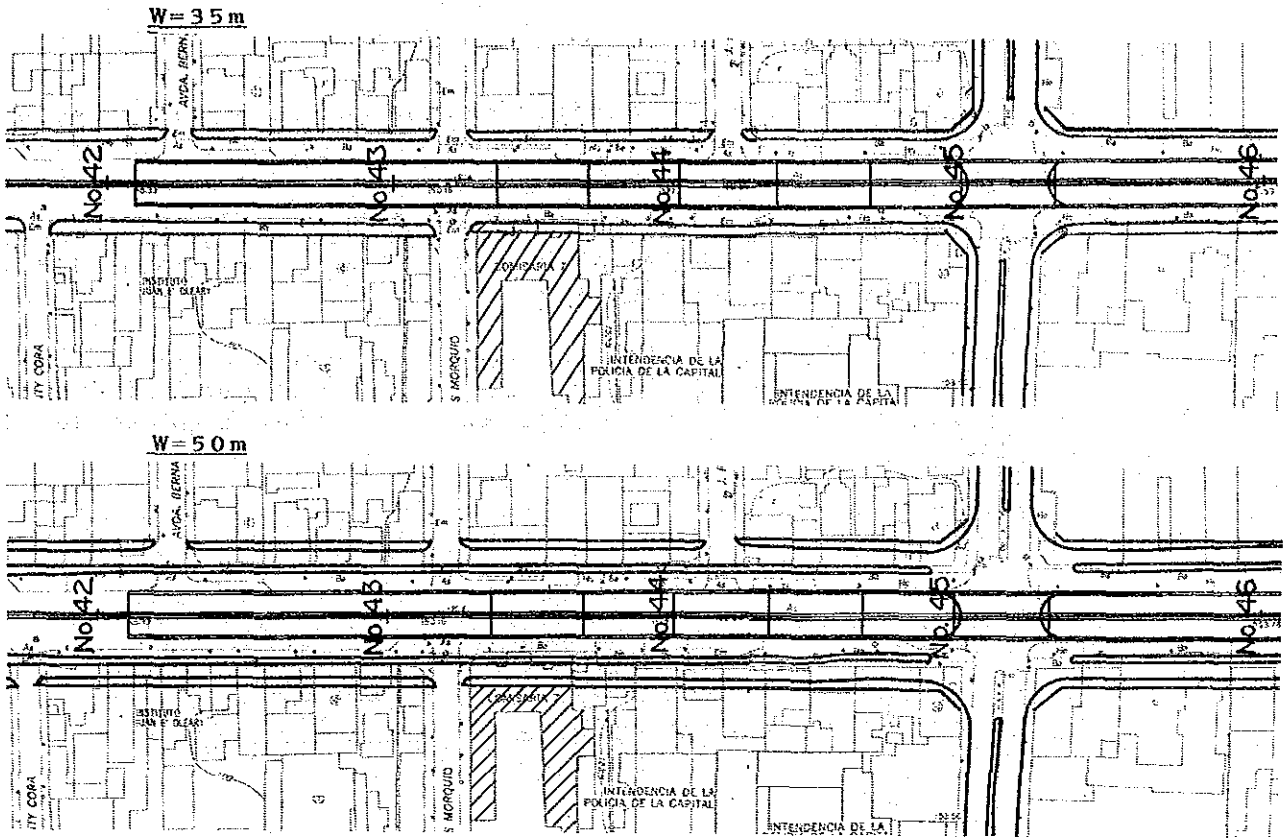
PLANO DE LA AV.E.AYALA (SECCION No. 43 + 50)
